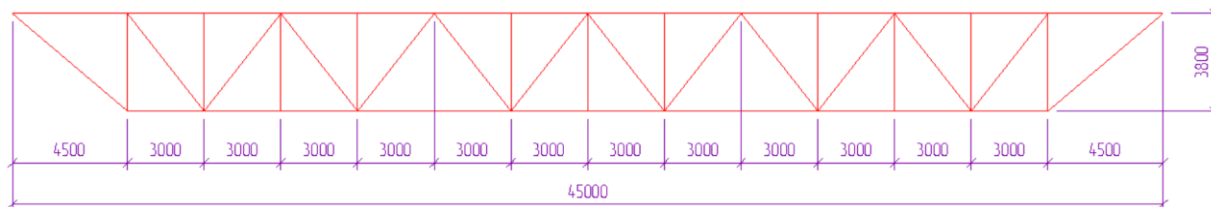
Расчетная схема стропильной фермы длиной 45 метров
